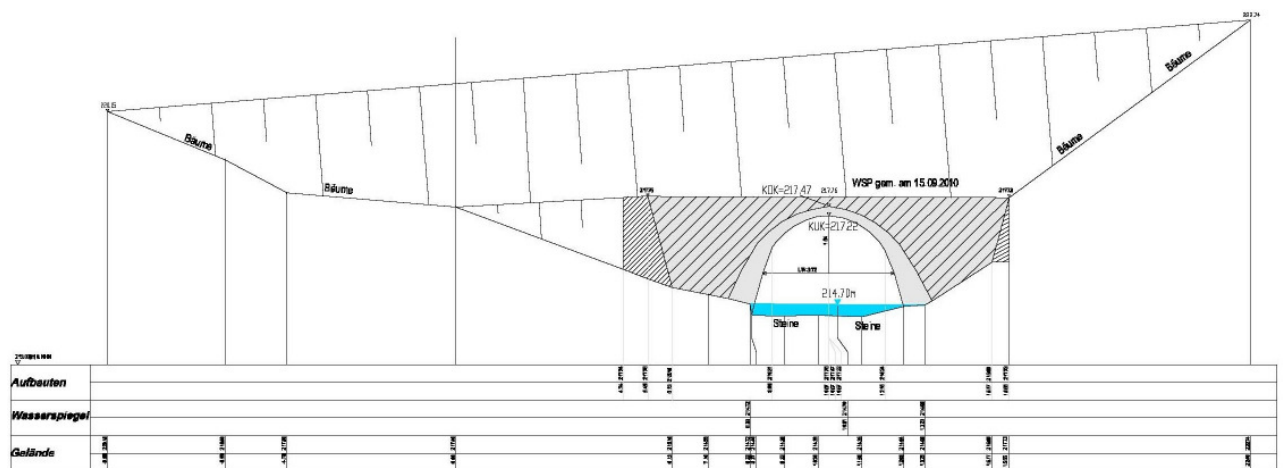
Auslaufbauwerk Ilsetunnel /5/
